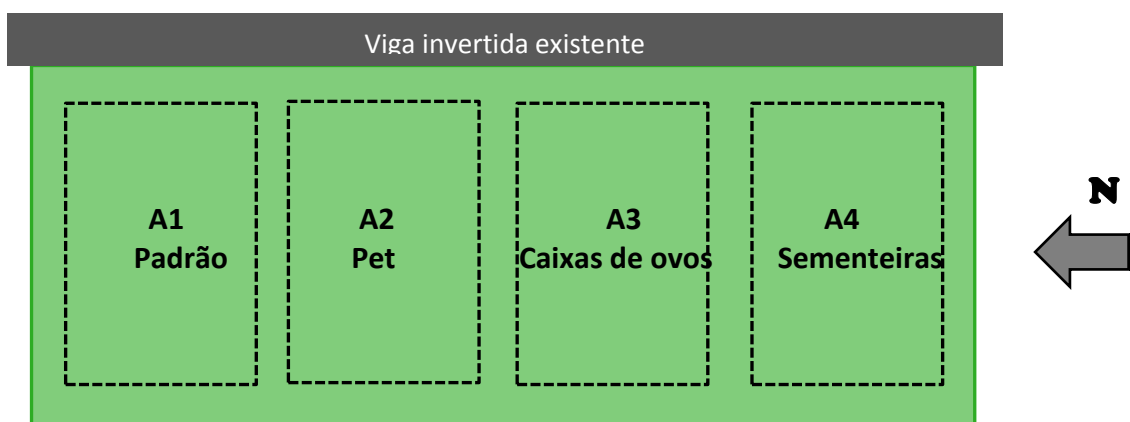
Esquema da disposição das áreas experimentais com diferentes dispositivos para armazenagem de água, em planta baixa.
